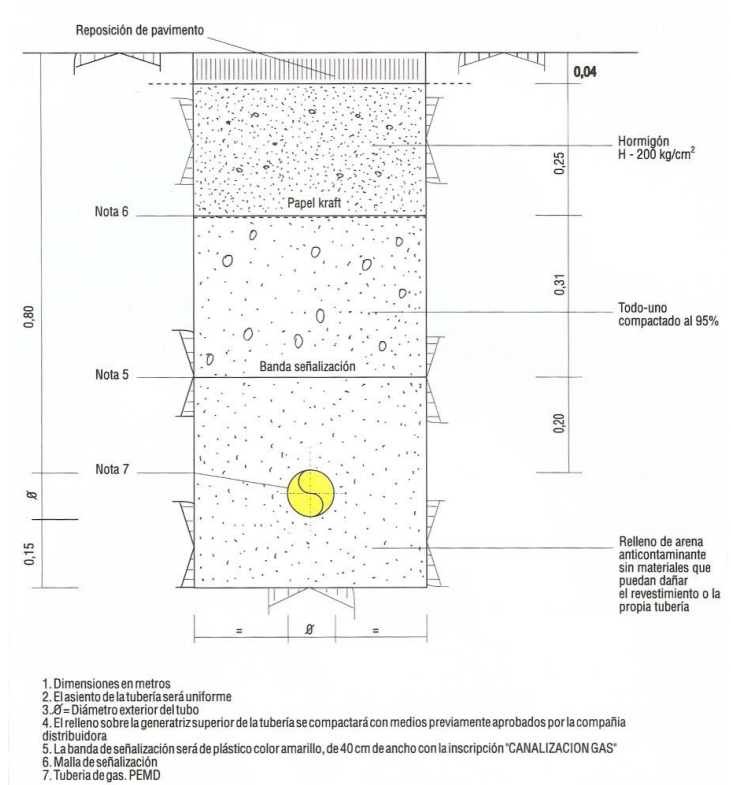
a Zanjas tipo. Zona urbana bajo calzada
